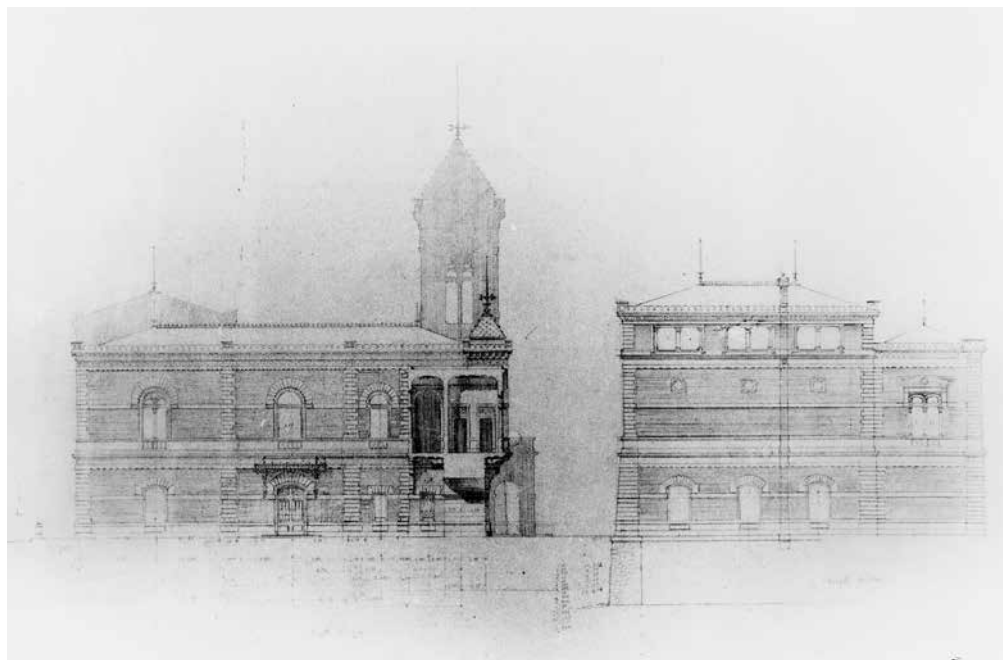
Alzato dei fronti posteriore e laterale (seconda variante)
